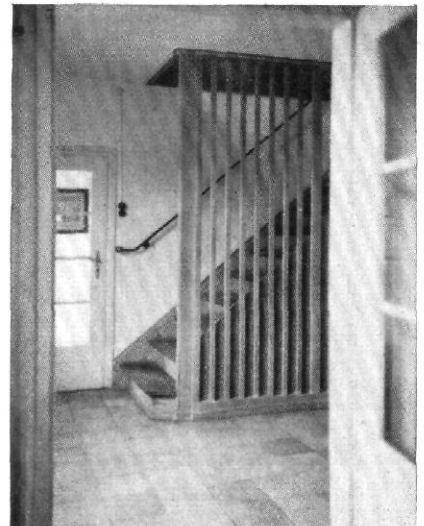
| Haustyp W | Treppe vom Erdgeschoß zum Obergeschoß | Hierzu Abb. 30, 34 u. 35 | Architekt: Paul Schmittbenner, Stuttgart
